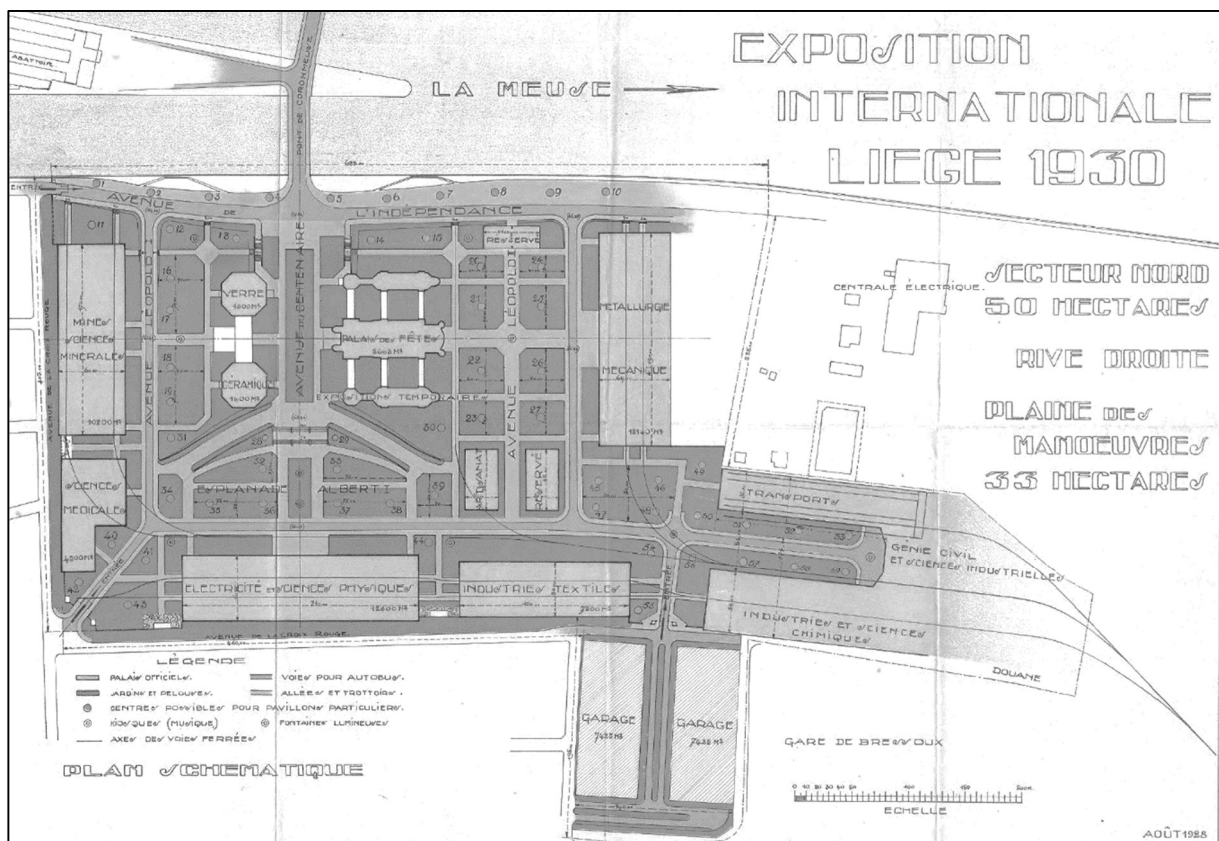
Plan de la section Nord rive droite de l'Exposition Internationale de Liège de 1930
